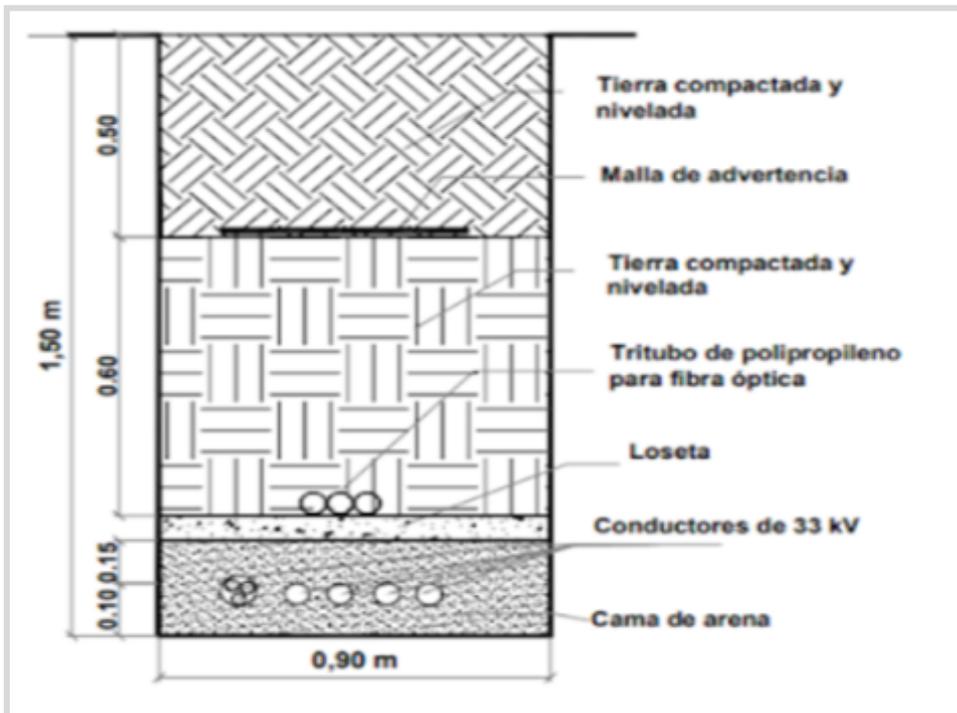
Esquema de corte para el trabajo de zanjeo.
